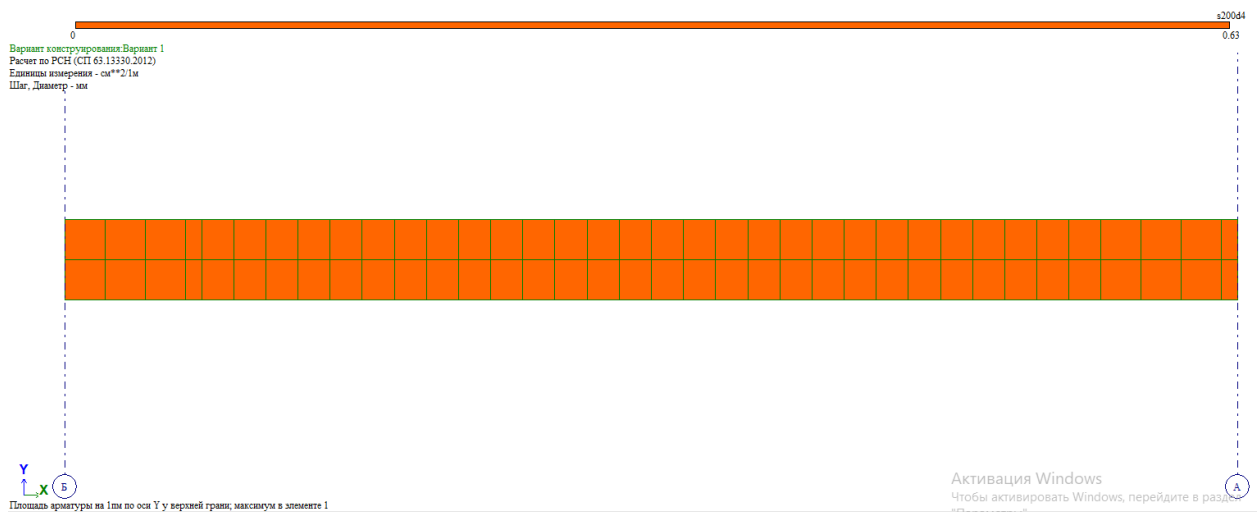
Подбор верхней продольной арматуры плиты по оси Y
